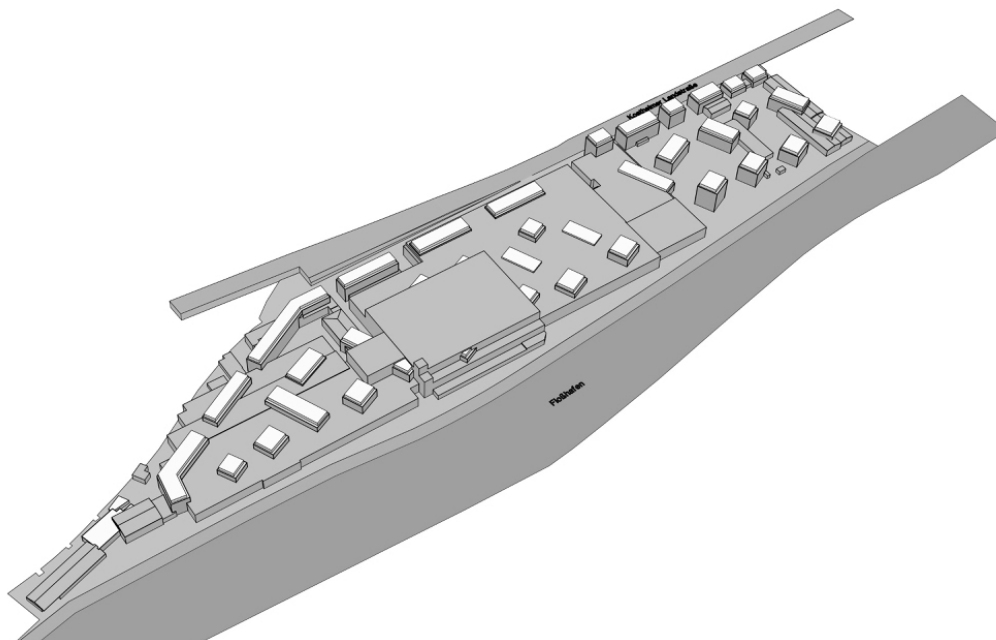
Baumassenvergleich „Werkhallen - Wohngebäude“ Blick Floßhafen
